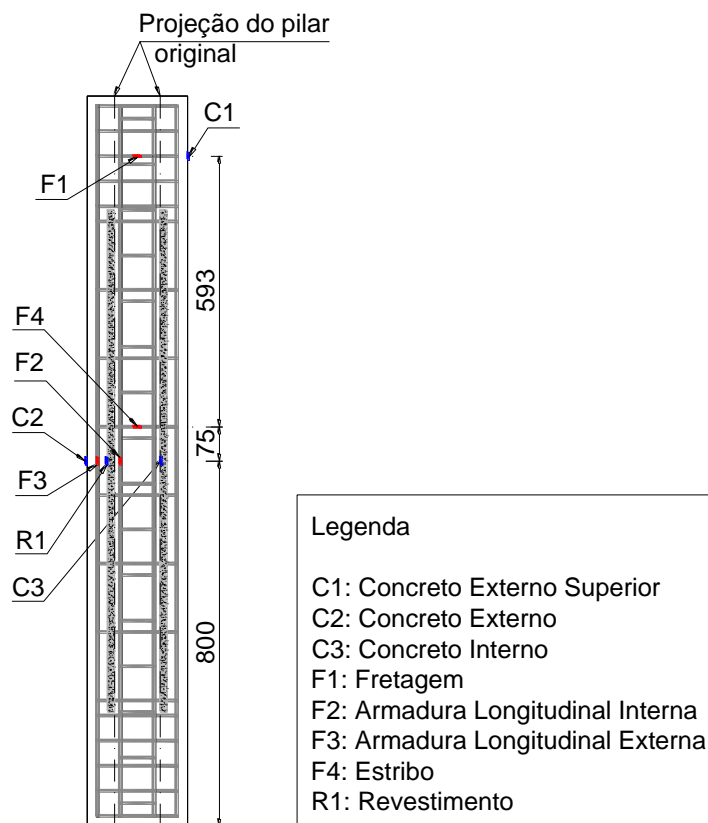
Posicionamento dos extensômetros do pilar PR₁₅₀
